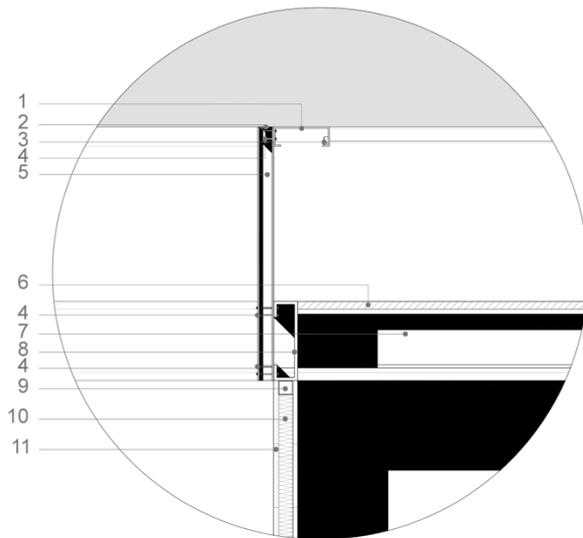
Detalle baranda/mesa exterior. Elaboración propia.
